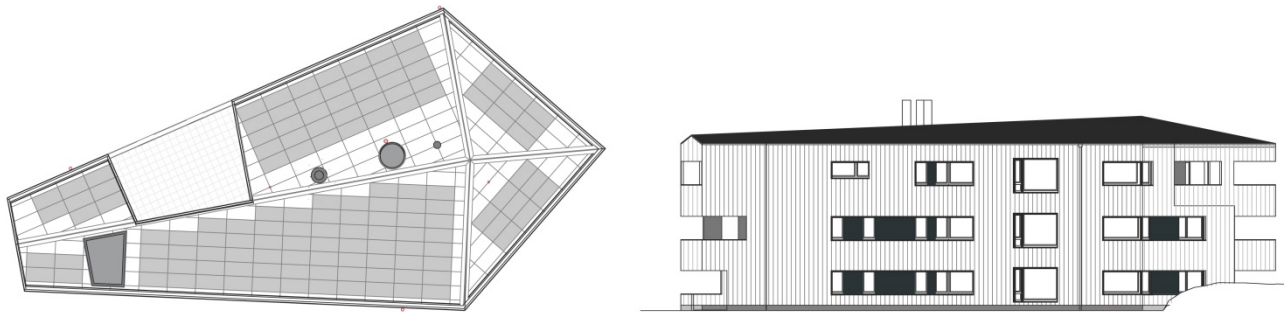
Mehrfamilienhaus: Dachaufsicht und Südfassade Quelle: (aardeplan 2014).
